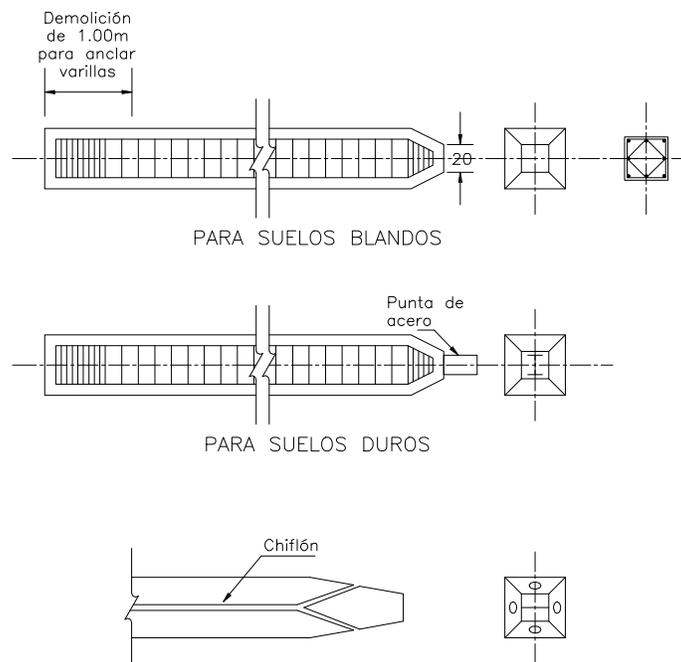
Pilotes de concreto para suelos blandos y duros.
